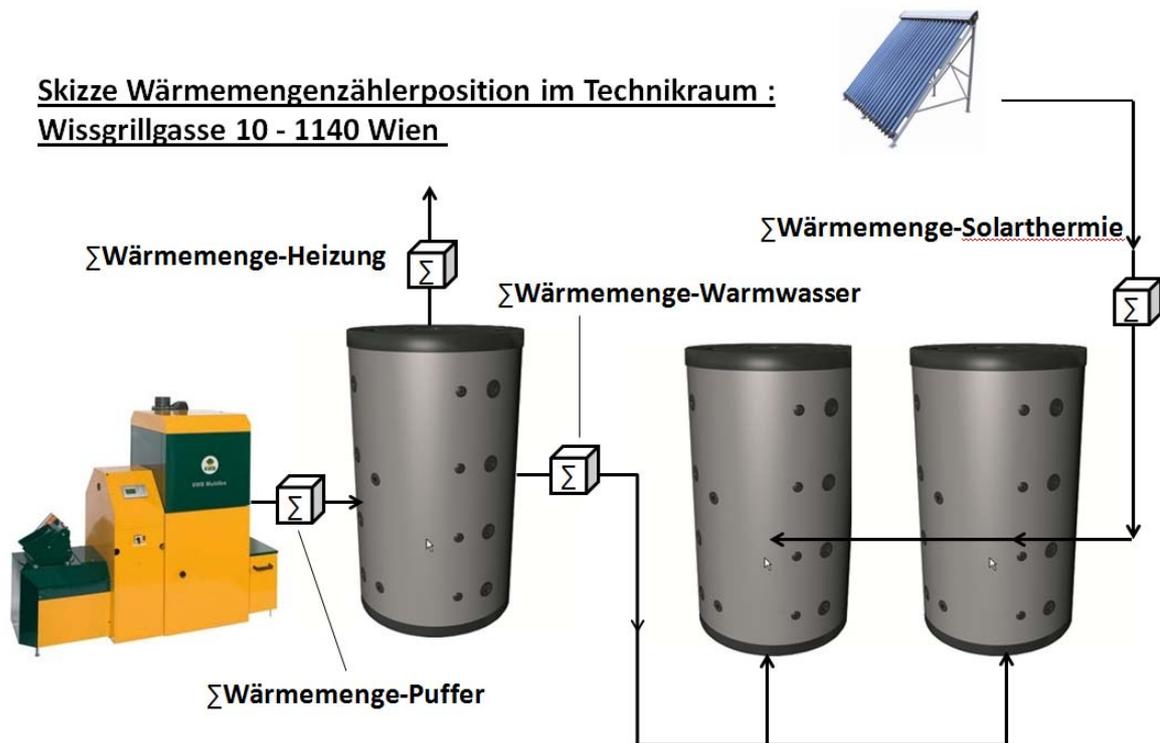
Positionierung Wärmemengenzähler im Technikraum
